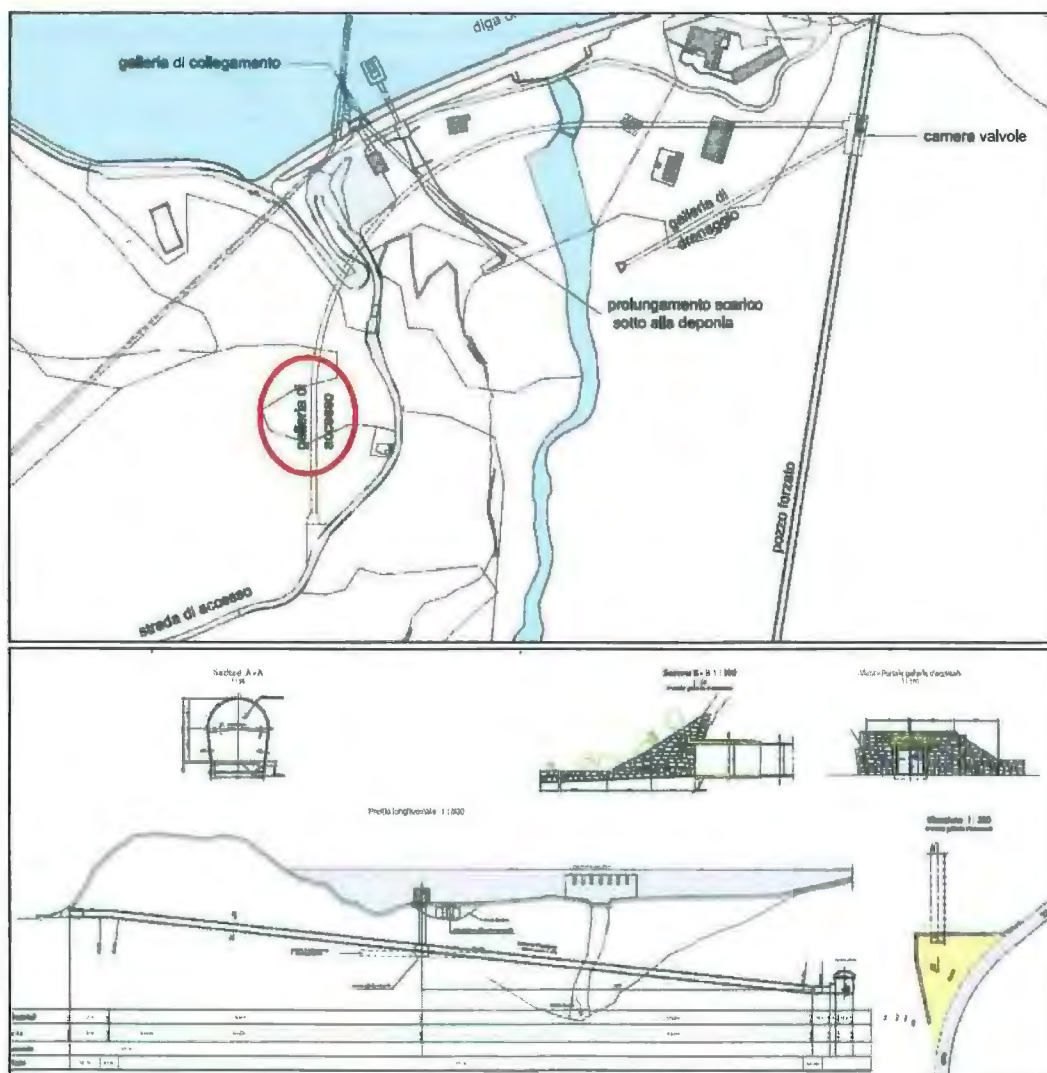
estratto planimetrico dei piani pubblicati in fase di concessione.
